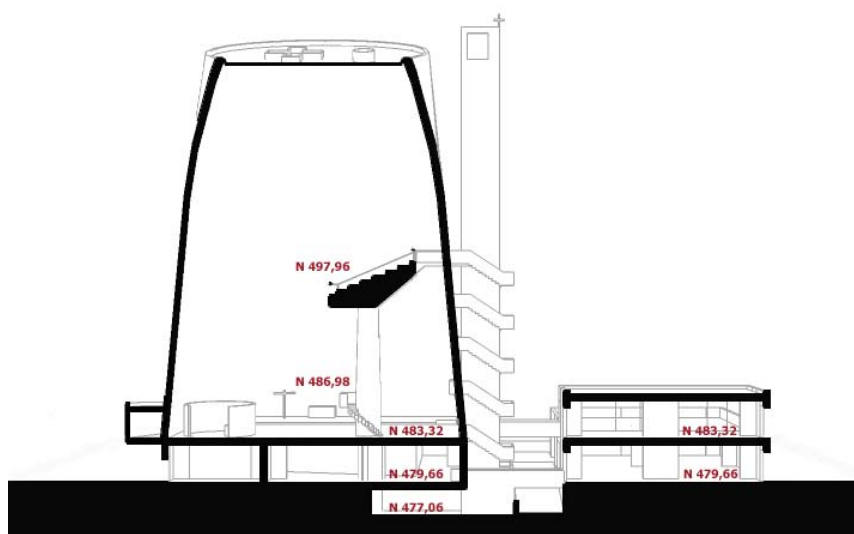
Dibujo en sección con las cotas y los niveles de la primera versión. Fuente: MCHS.
